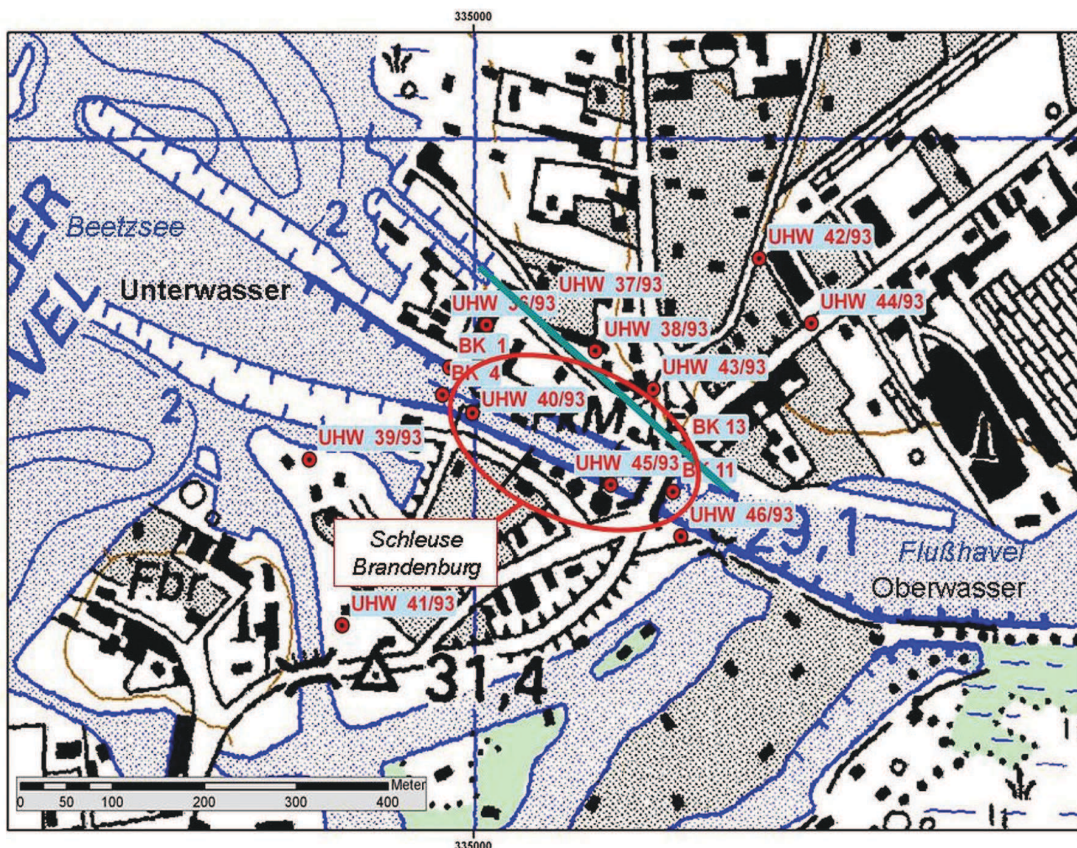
Lageplan der GW-Messstellen im Bereich der Schleuse Brandenburg
